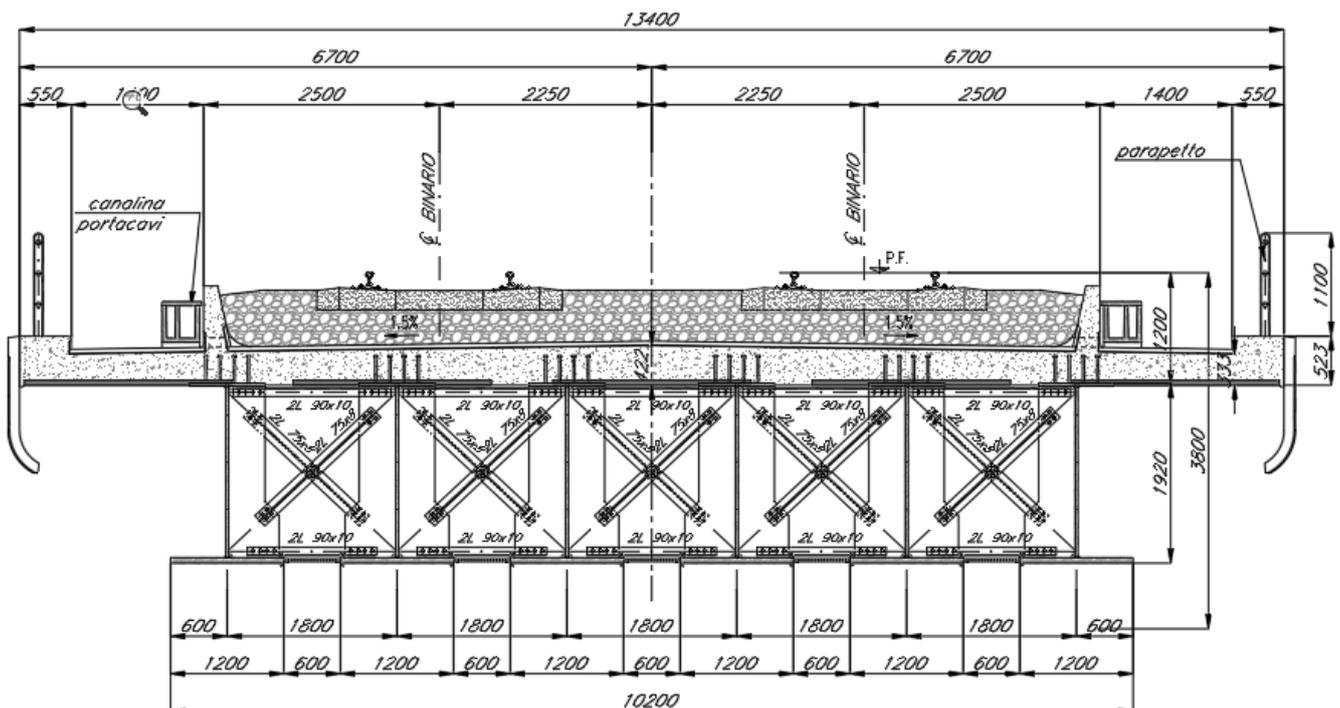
Sezione trasversale dell'impalcato misto a 6 travi
